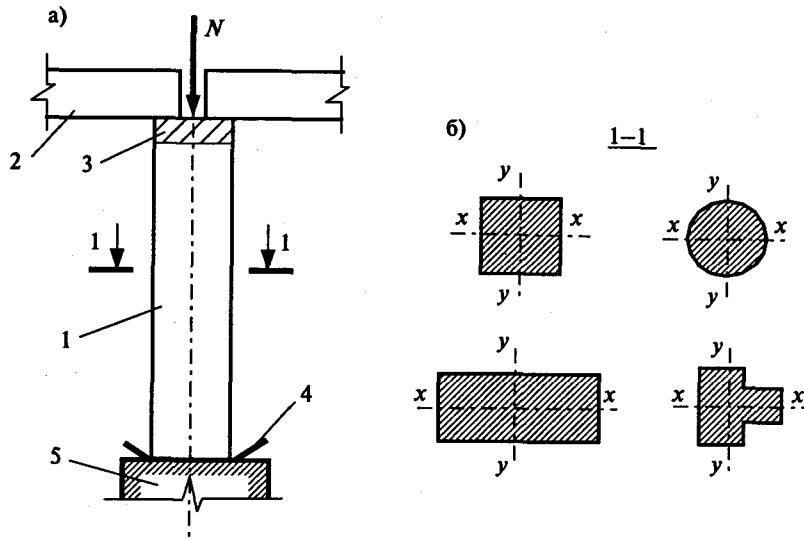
а) кирпичная колонна; б) сечения кирпичных колонн; 1 — колонна (столб); 2 — балка; 3 — железобетонная подушка; 4 — гидроизоляция; 5 — фундамент
